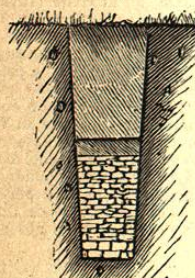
Drain ordinaire en pierres plates non schisteuses.
